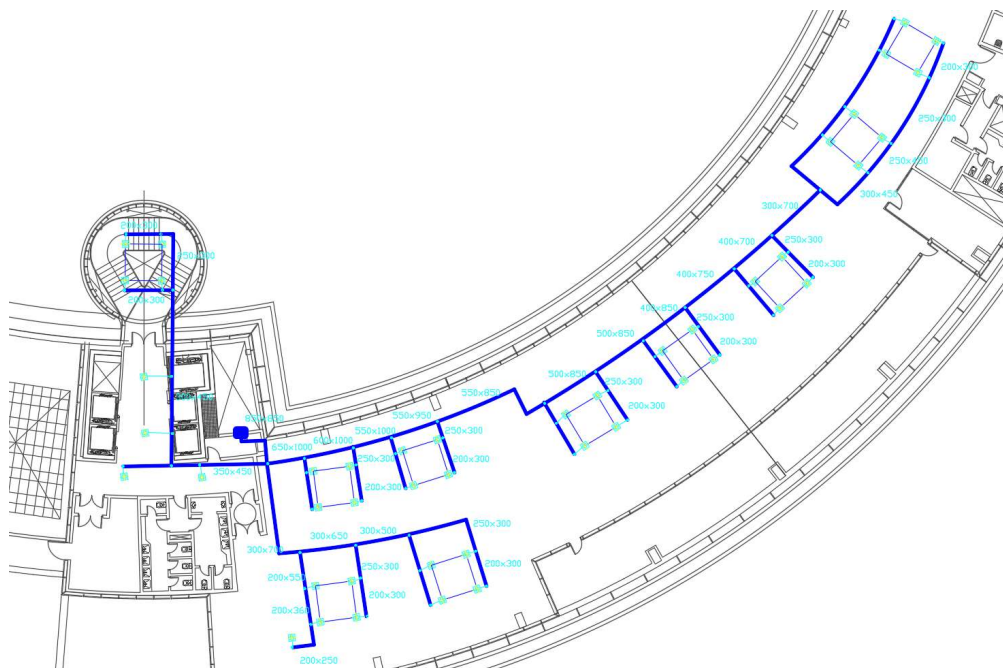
Planos conductos de impulsión aire Planta segunda Zona norte
